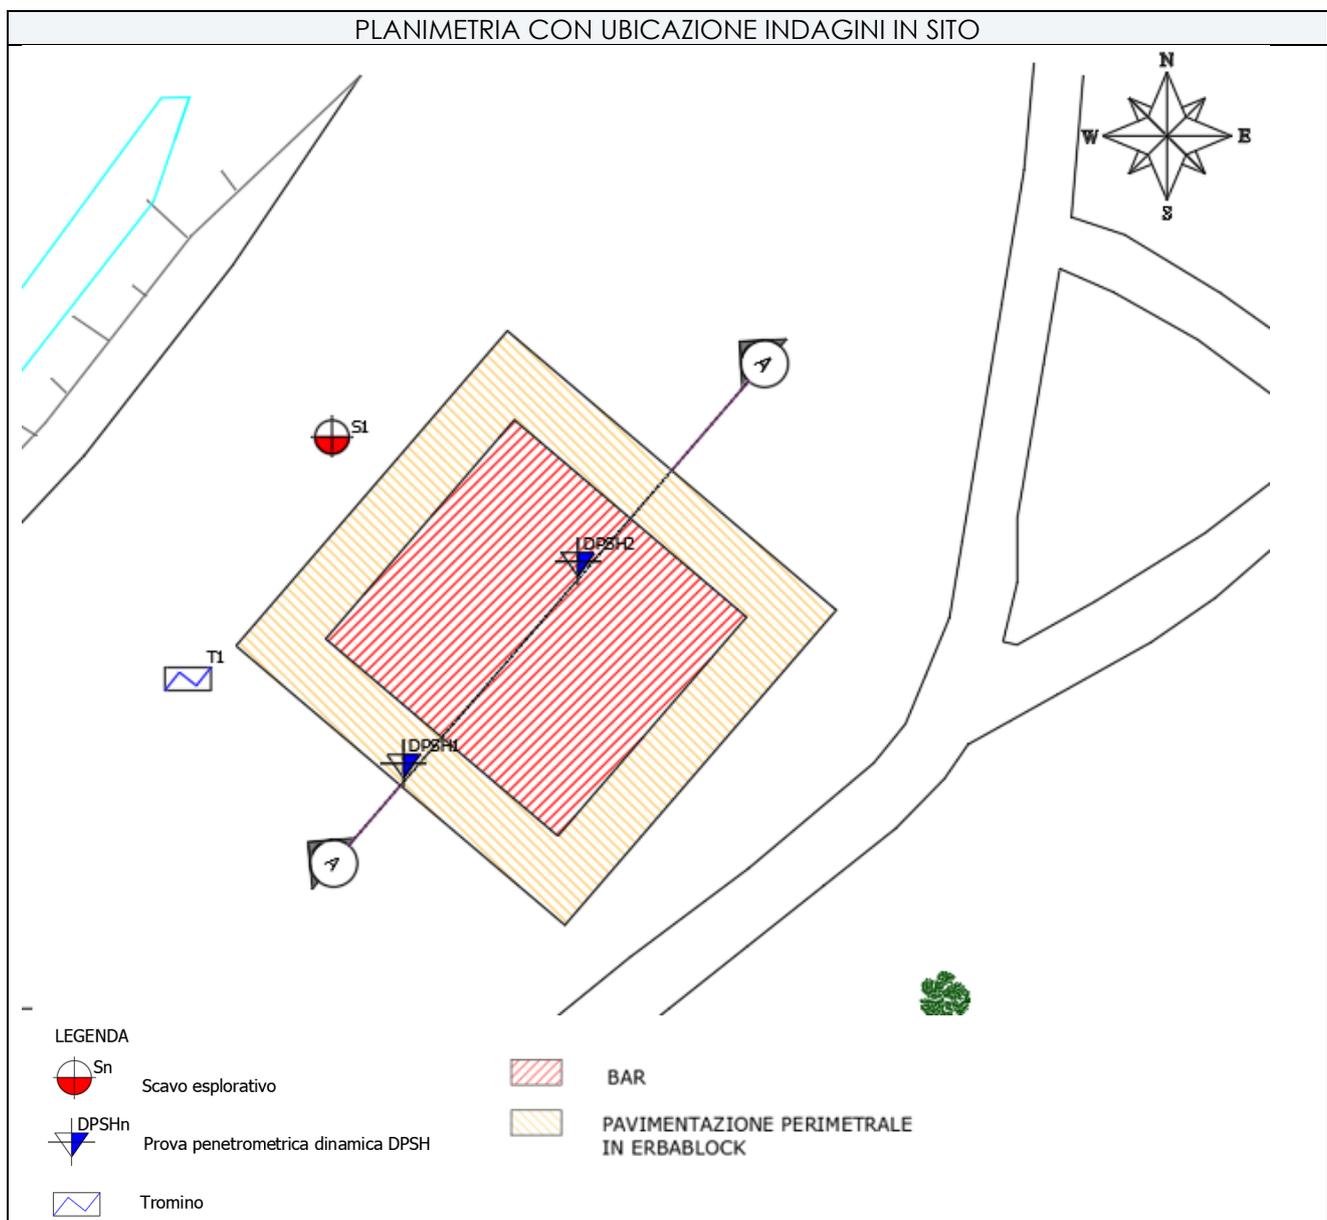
Planimetria dello stato di fatto con ubicazione indagini in sito.
